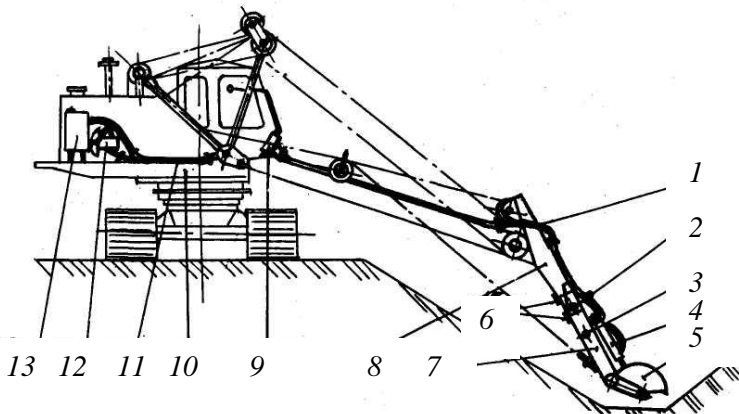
Общий вид поворотного ковша экскаватора с канатно-блочным управлением.
